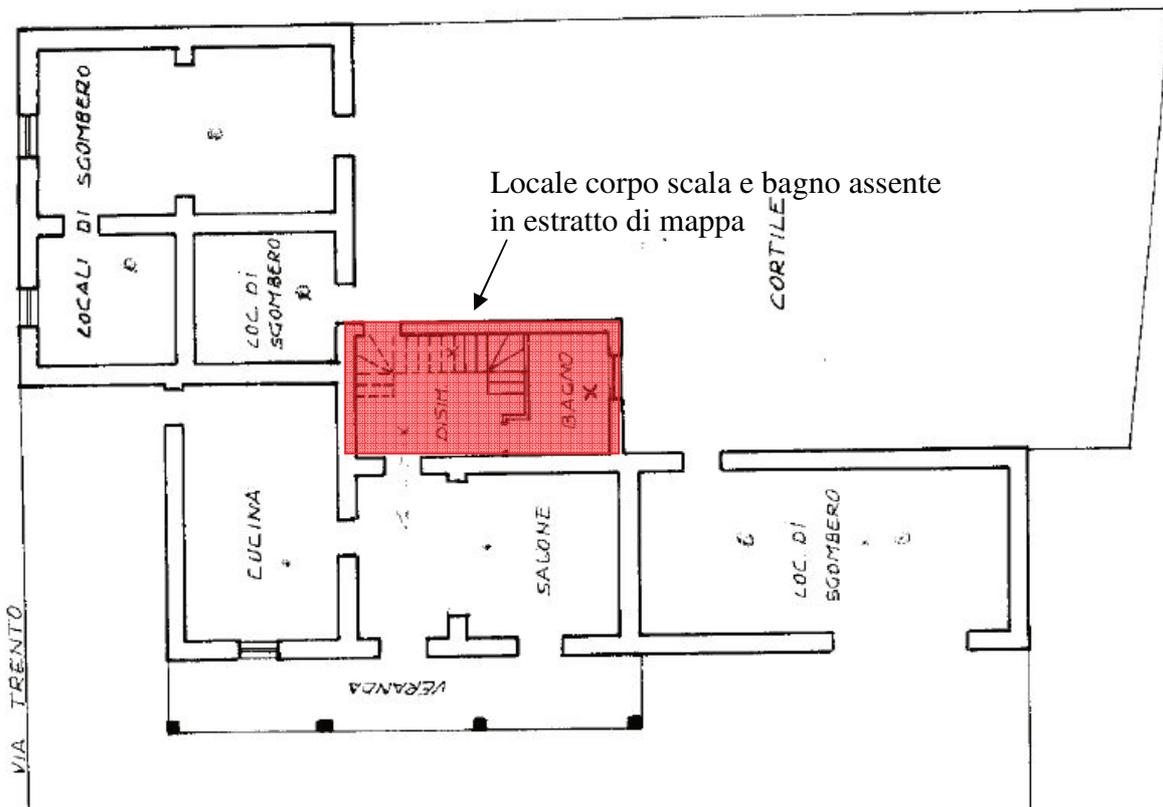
Planimetria catastale piano terra con indicazione del Sub. 1
